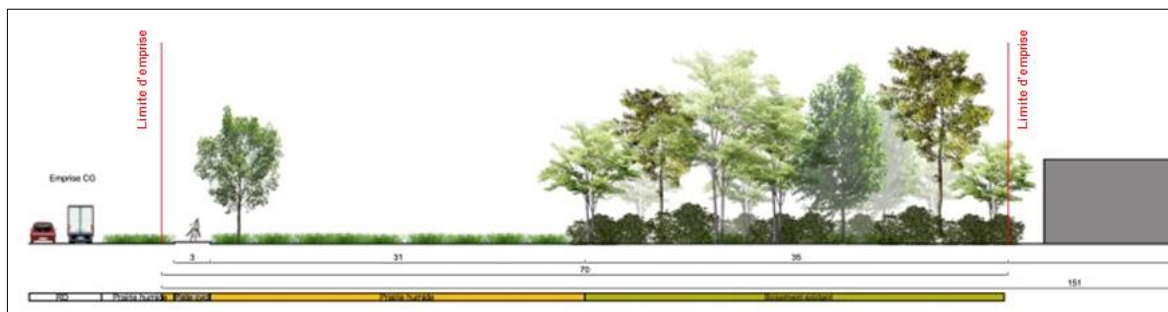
Vue en coupe : zoom sur le traitement en façade du site
